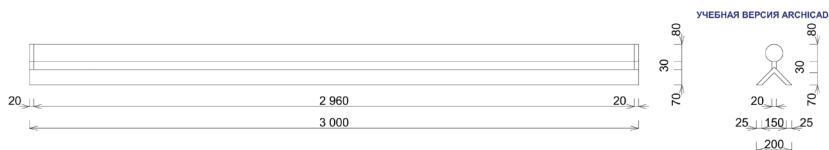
Схема трубкового освітлювального приладу для колони з габаритними розмірами
